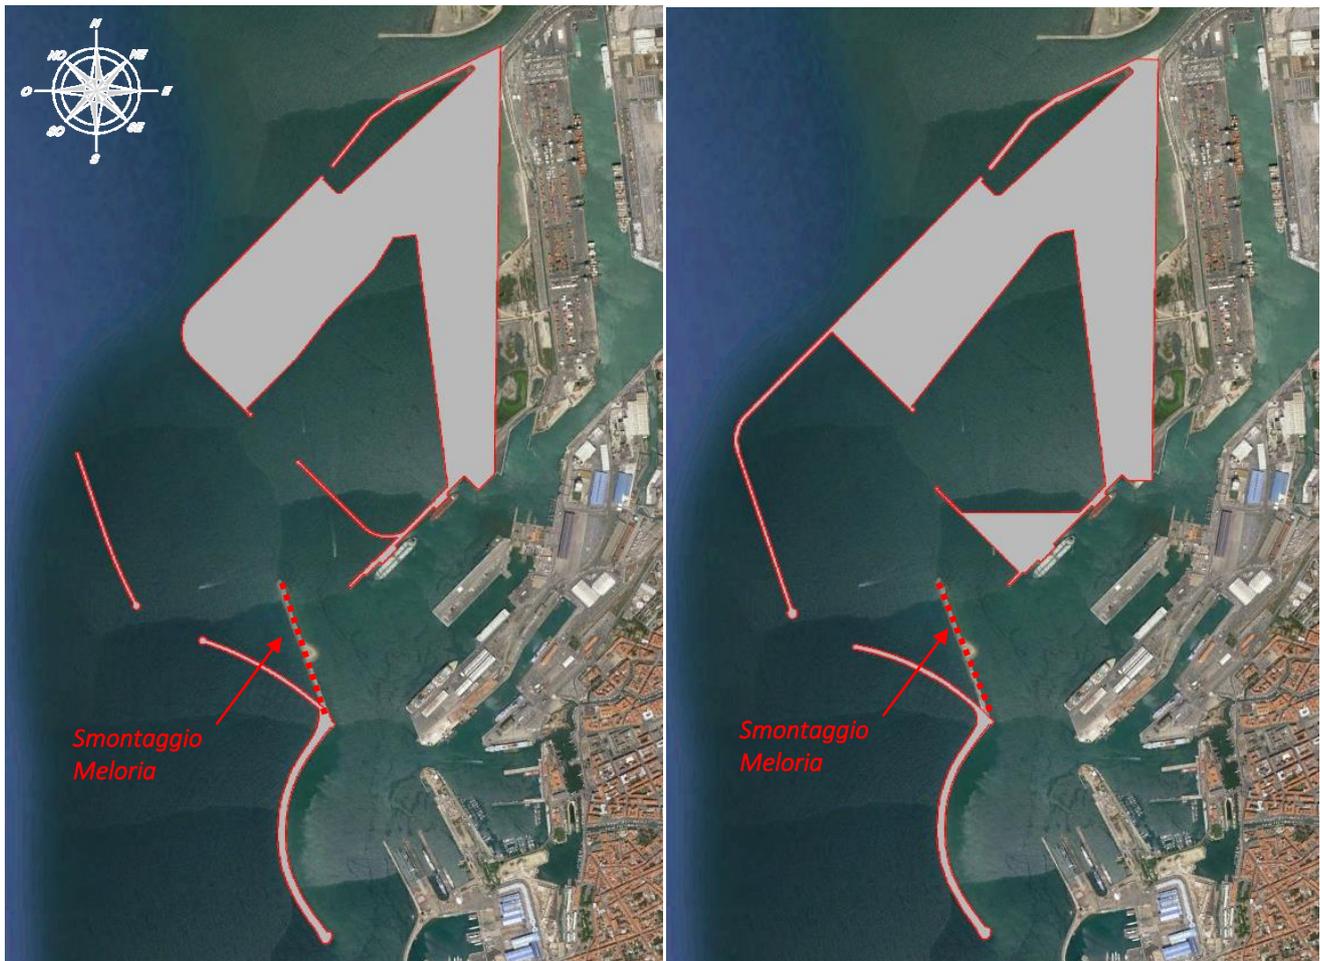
Layout di prima fase previsto dal P.R.P. e layout prima fase proposto dal R.T.P. (con chiusura diga Nord)
